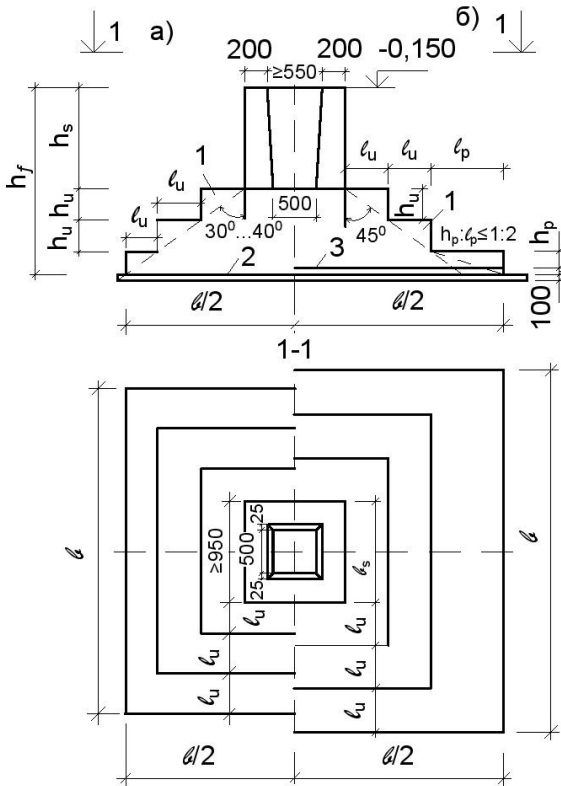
Монолитные железобетонные столбчатые фундаменты стаканного типа: а – жёсткий; б – жёсткий с нижней гибкой ступенью-плитой; 1 – фундамент; 2 – бетонная подготовка; 3 – арматурная сетка
